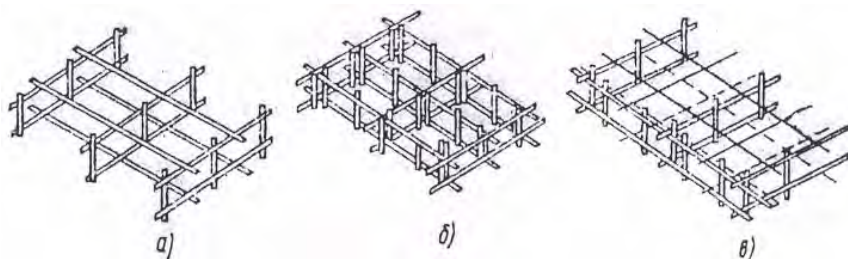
Примеры конструкций пространственных каркасов для армирования плоских железобетонных элементов: а – из плоских сеток типа лесенка и соединительных стержней; б – из плоских сеток типа лесенка одного направления и таких же сеток другого направления, но меньшей высоты; в – то же, с добавлением одной или двух плоских сеток
